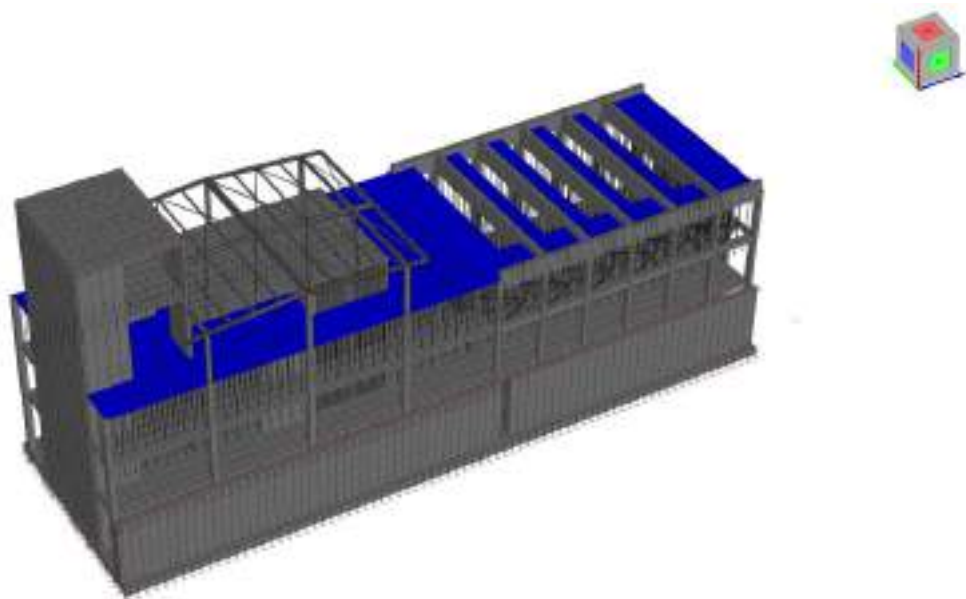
implementazione del carico pacchetto pavimentazione L2 – $g_k = 3.60 \text{ kPa}$.
